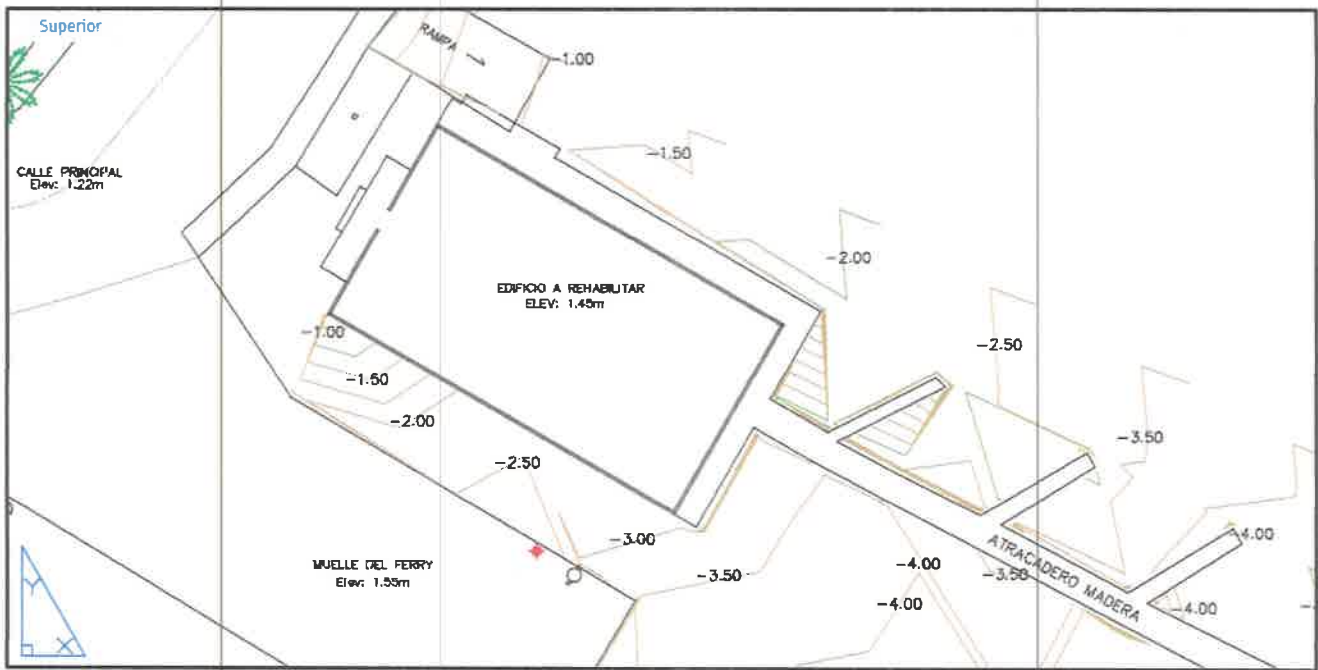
Detalle del Plano de la Topografía del proyecto donde se destaca la elevación de las principales infraestructuras y la calle principal
